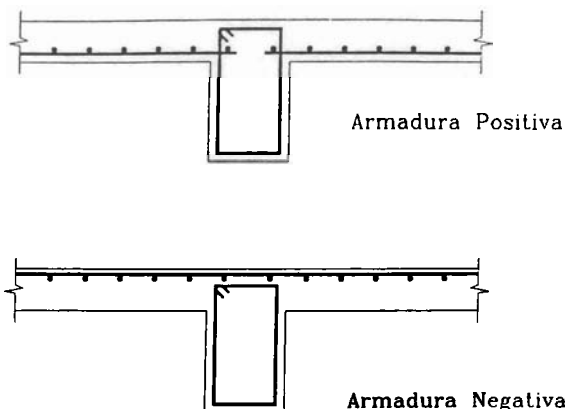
Detalhe de ancoragem de tela soldada em uma viga interna
